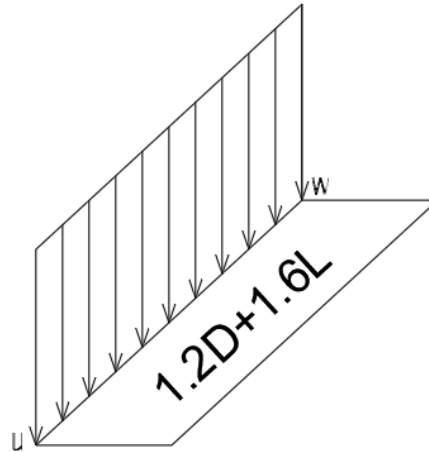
Visualización de Cargas aplicada a vigas perimetrales
